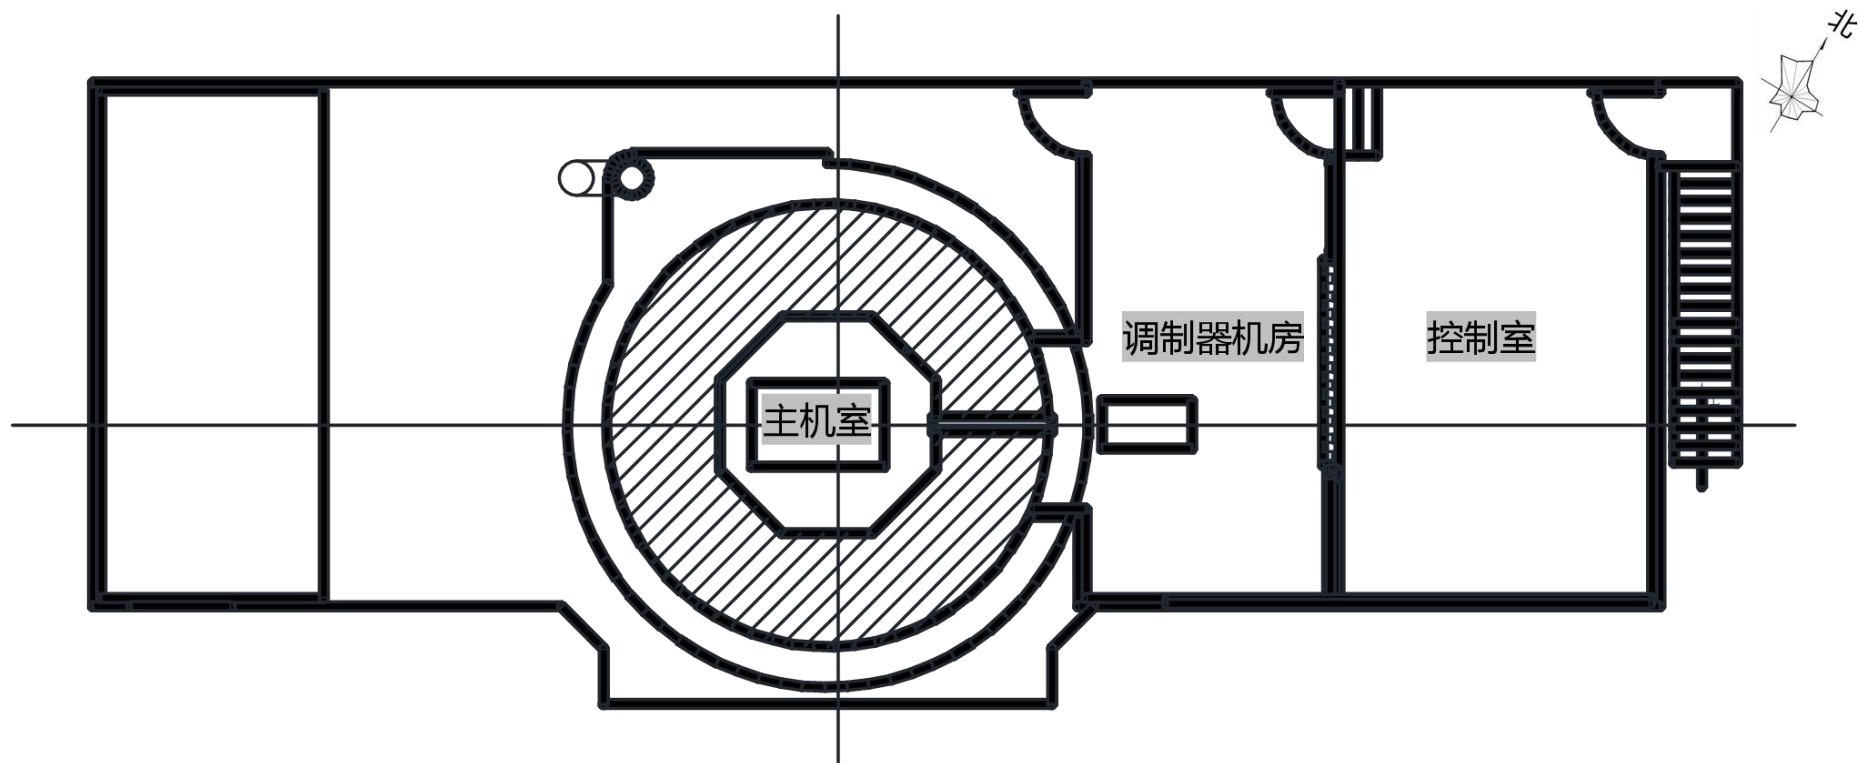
(3) 本项目加速器机房地上二层（主机室）平面布置图
